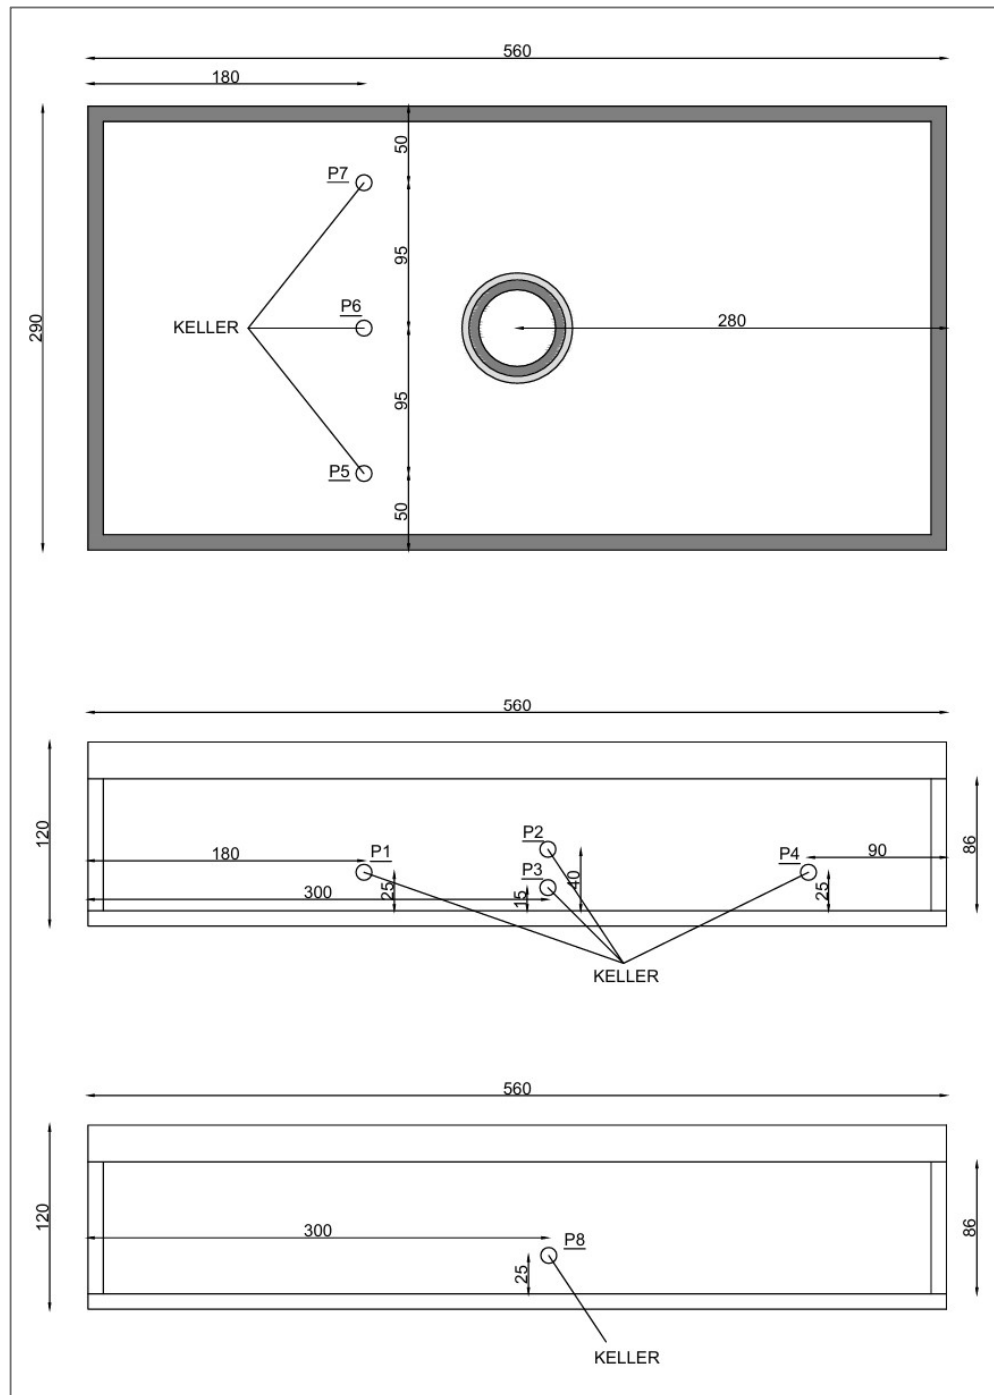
Disegni impalcato e posizionamento dei sensori di pressione (vista in pianta, prospetto frontale e retro).
